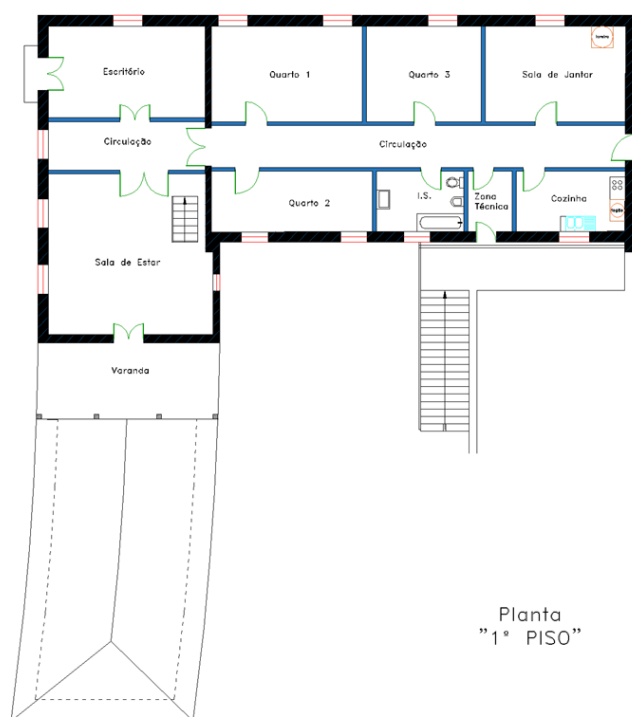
Planta com a arquitetura proposta ao nível do 1º piso.
